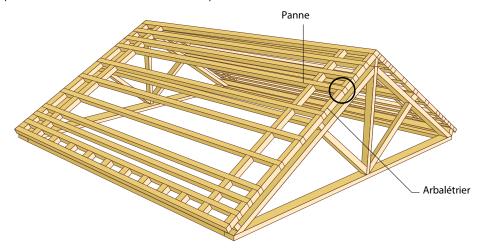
Exemple de fixation des pannes sur l'arbalétrier
